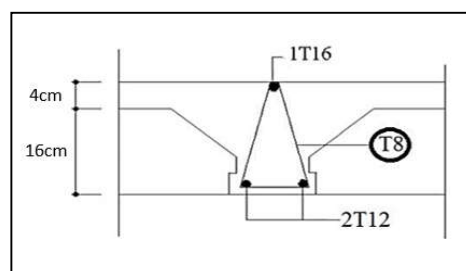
Schéma de ferrailage de la poutrelle étage courant.
